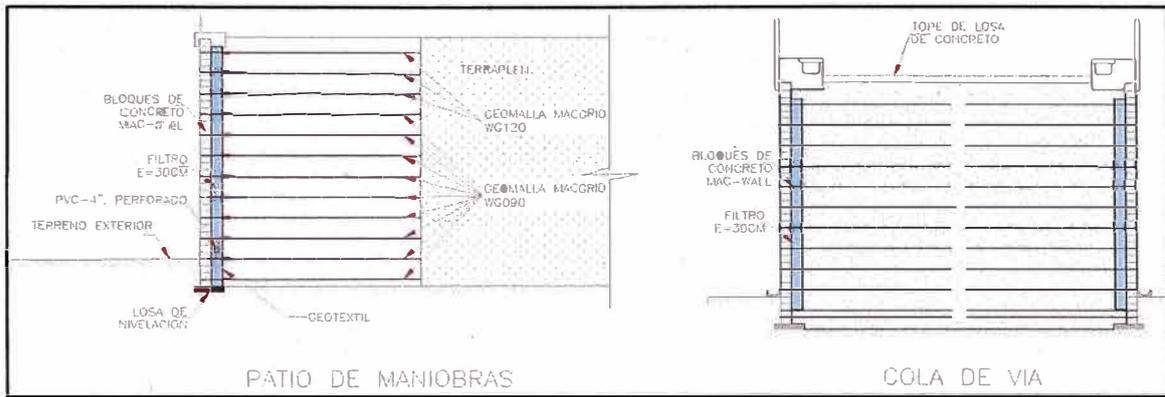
Muro de suelo reforzado – Ubicación de Filtro y Geotextil.
